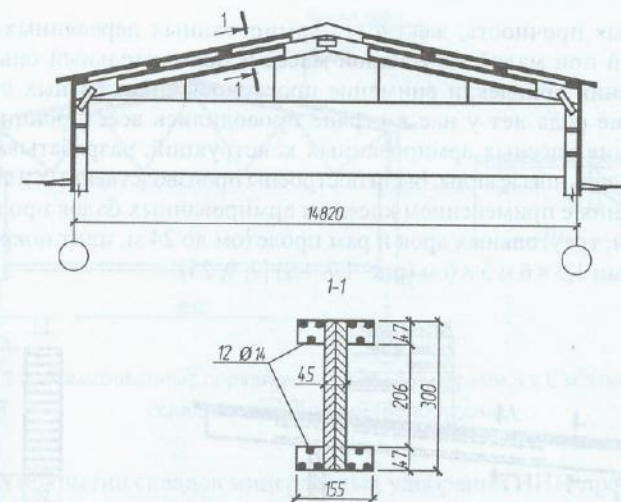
Клееная армированная треугольная арка в покрытии производственного здания (Швеция)
